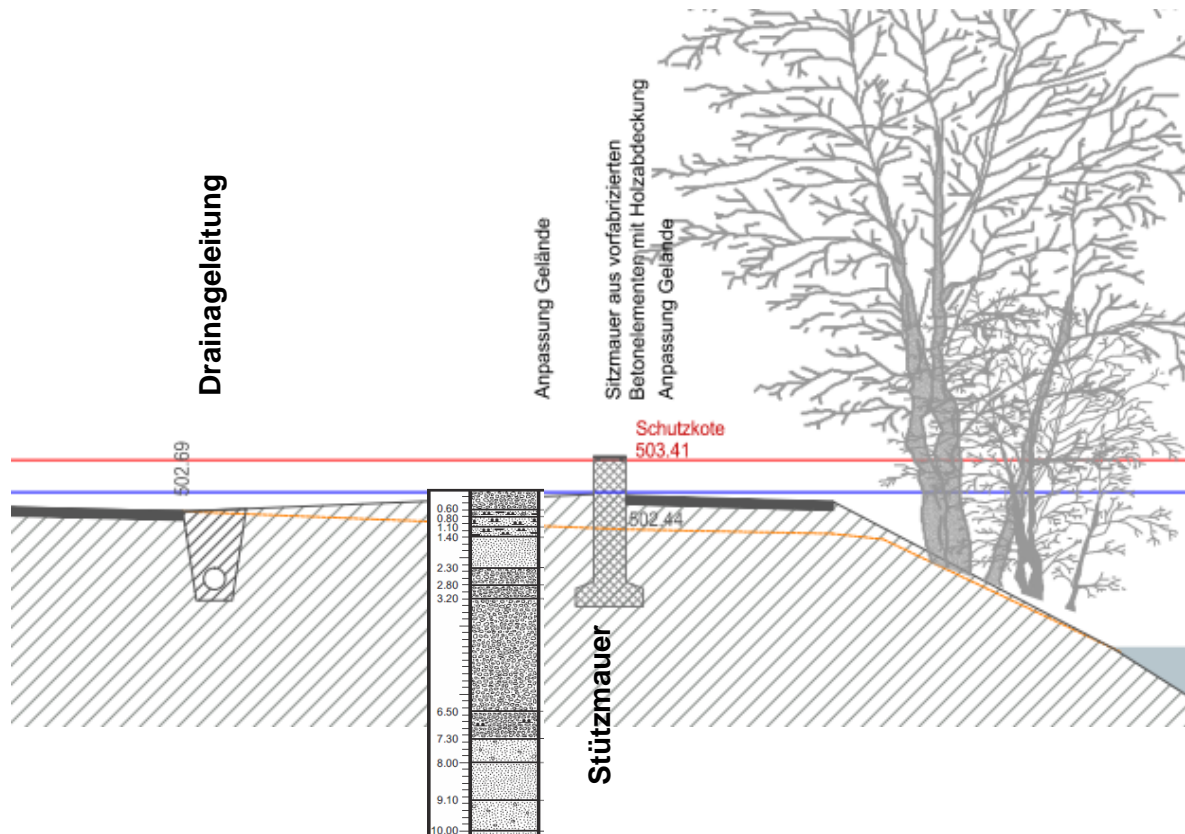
Bezüglich Untergrund relevante bauliche Massnahmen: Drainage und Stützmauer.
